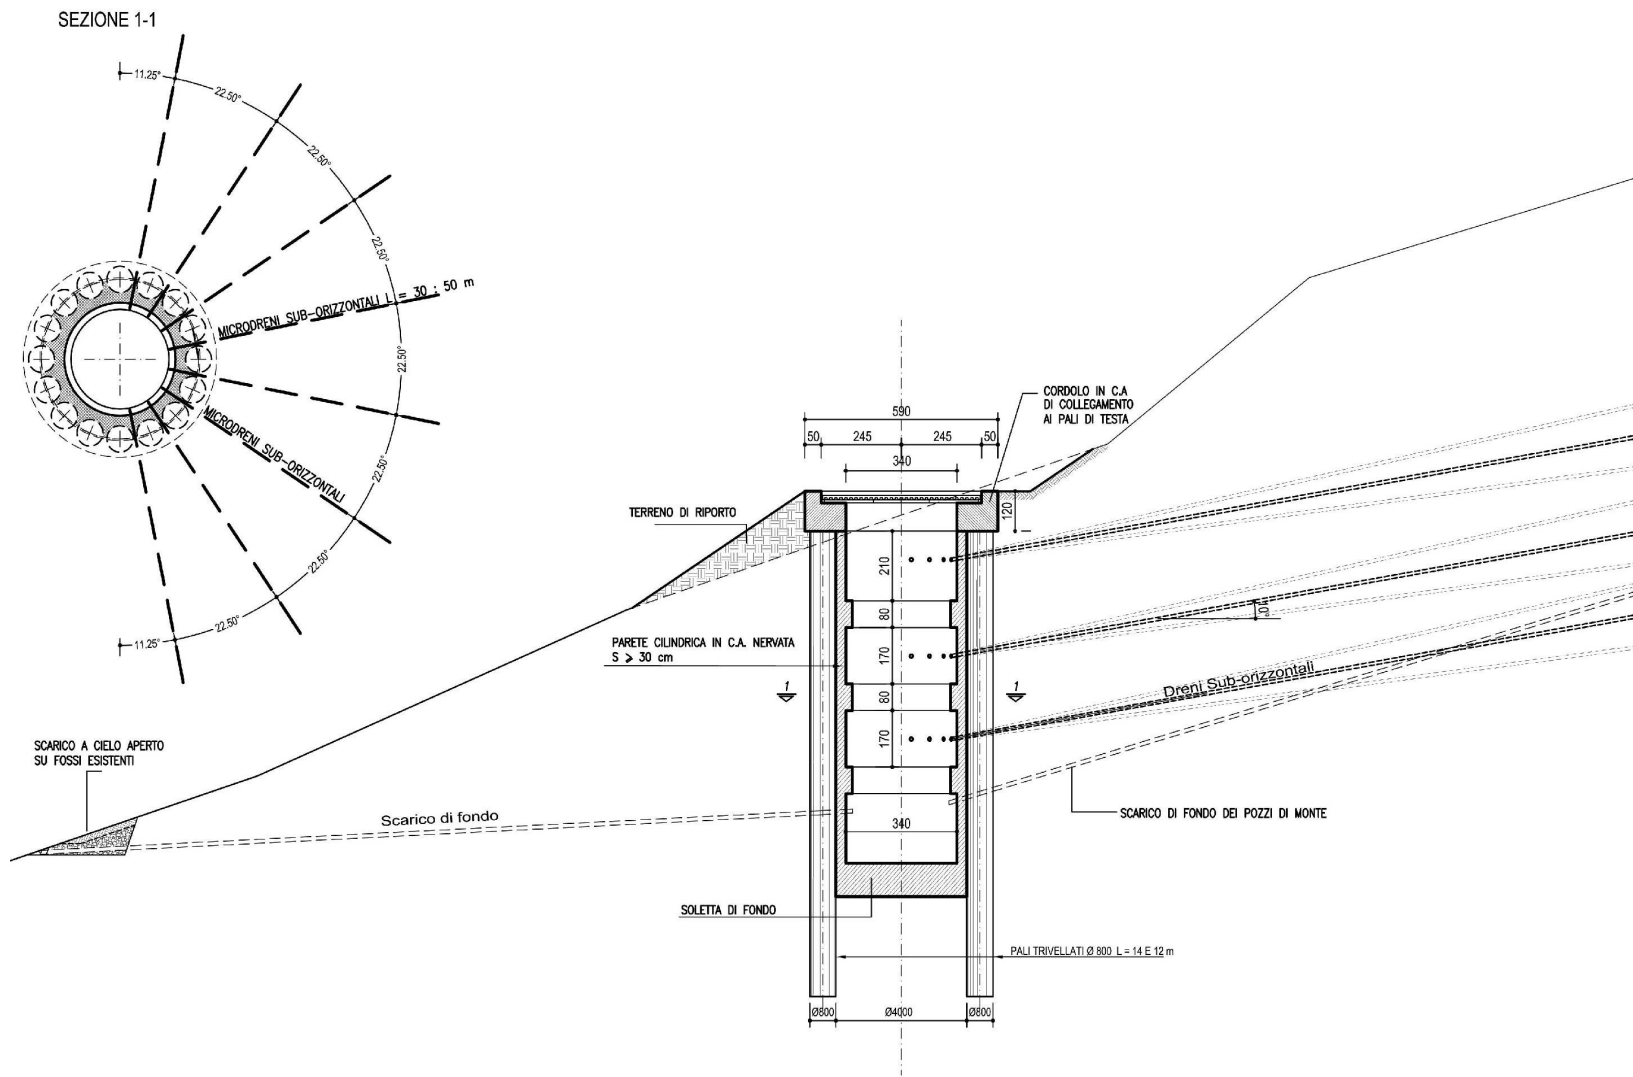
Sezione tipo dell'intervento dei pozzi drenanti.
